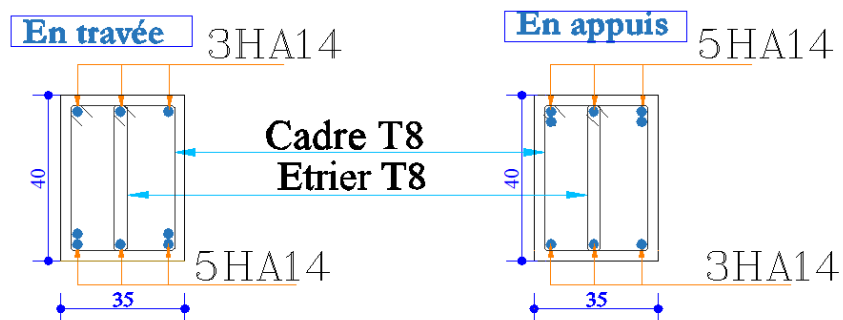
Schéma de ferrailages des poutres PP/PS.
